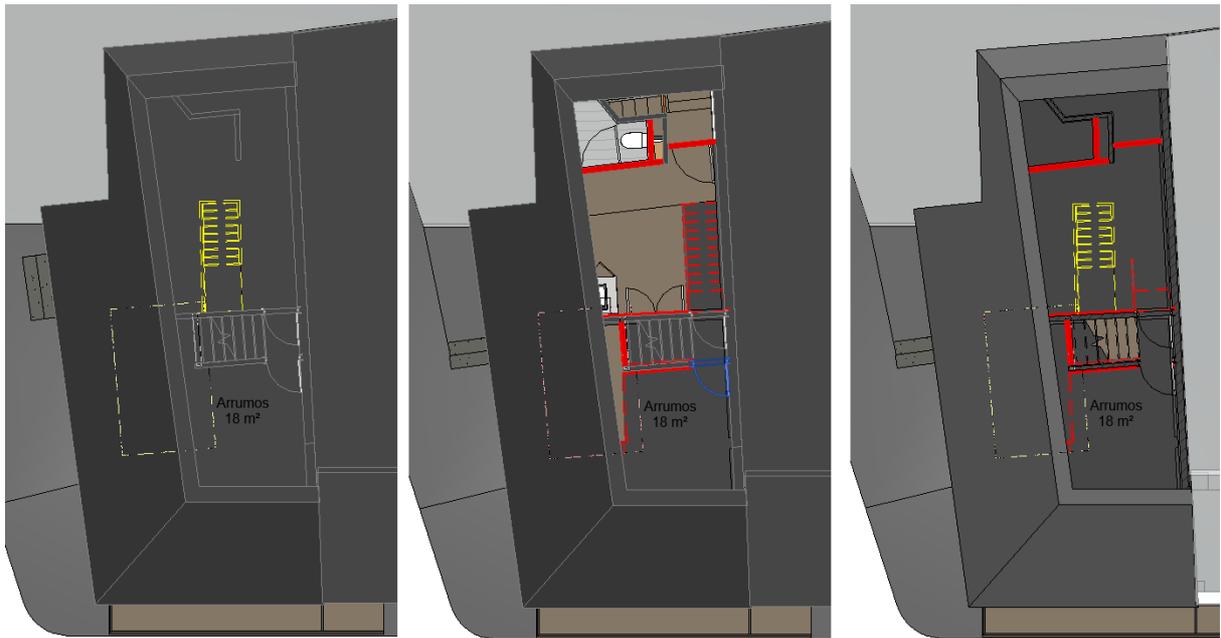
Plantas sótão - a demolir, a construir e vermelhos e amarelos
